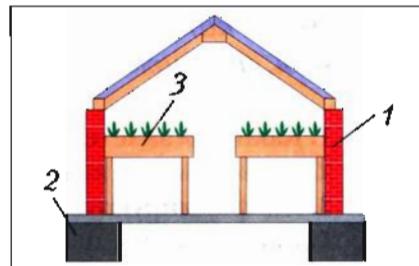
Двускатная зимняя теплица: 1 – стена, 2 – фундамент, 3 – стеллаж
